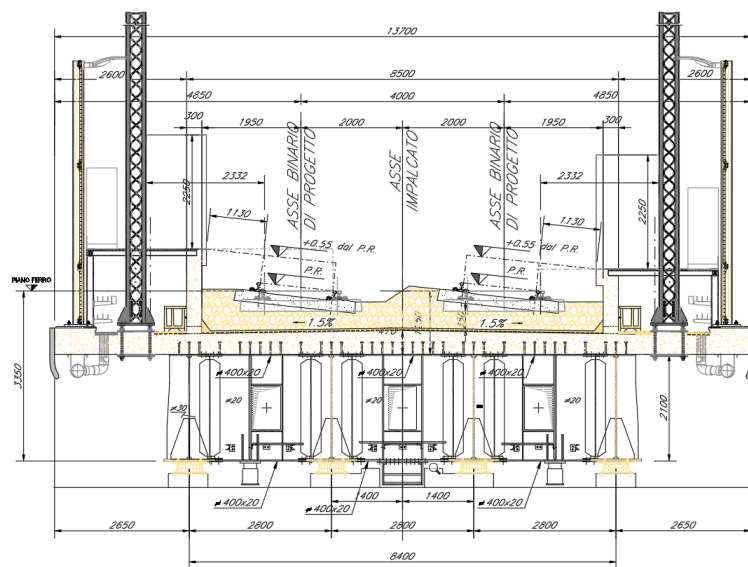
Sezione trasversale tipo (H travi = 2.10 m) – testata
